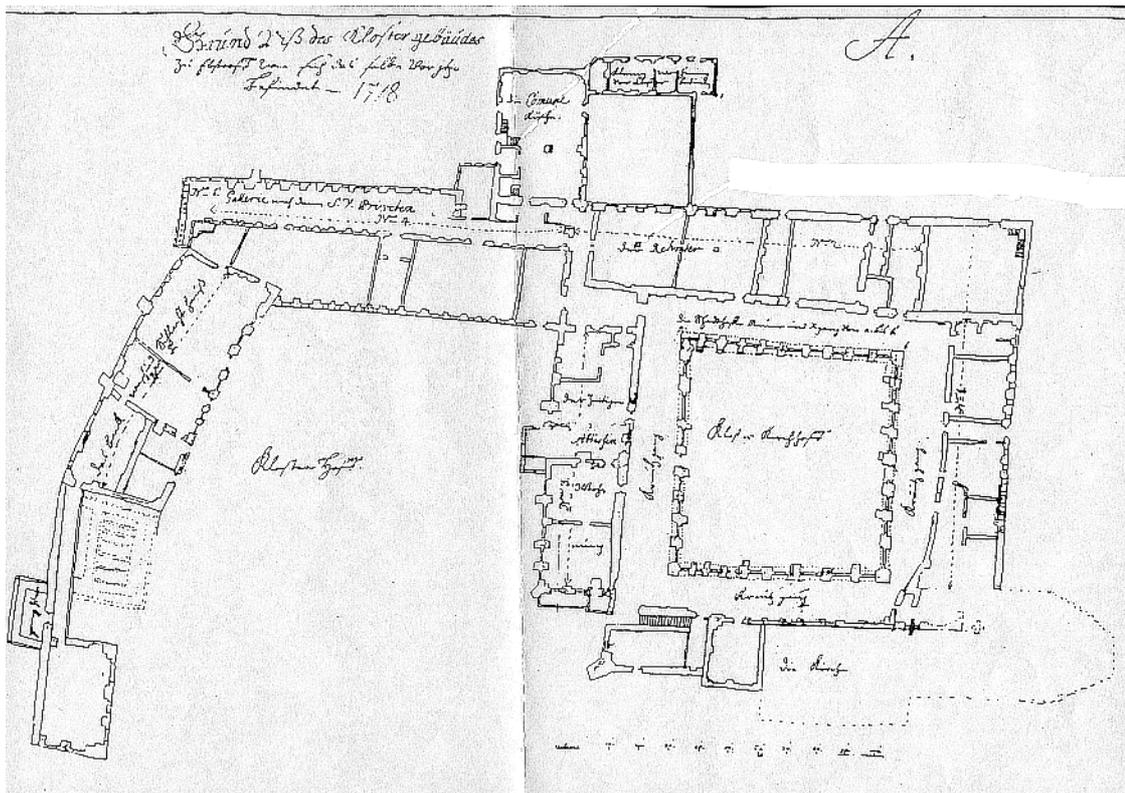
Grundrissplan des Erdgeschosses von 1718. Klosterarchiv.
